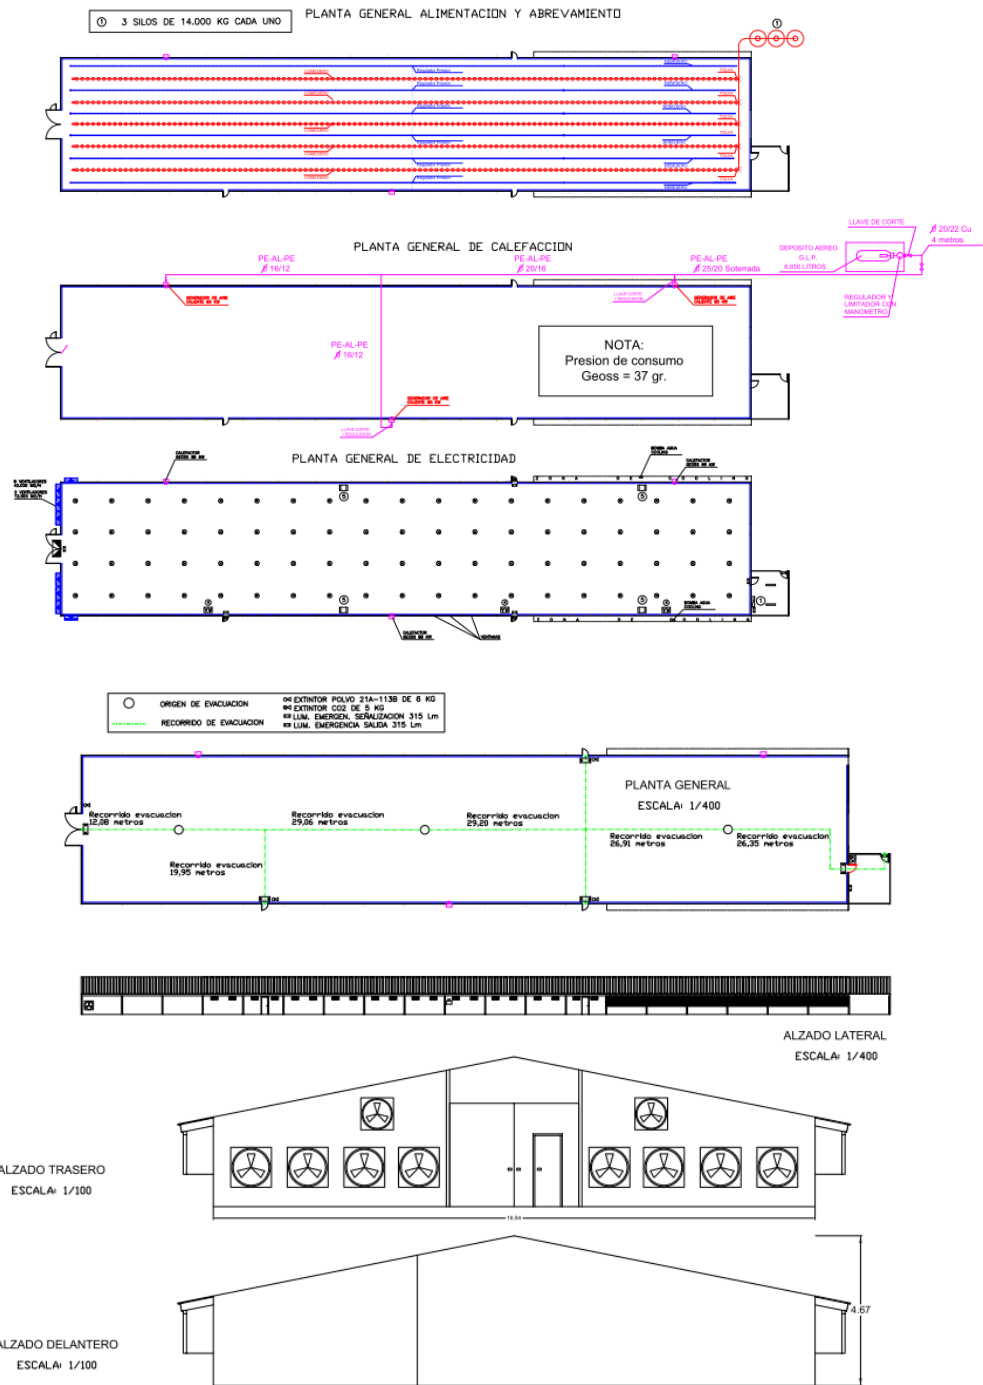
Planta y alzado de la nave nº 3. Localización de los focos de ruido.
